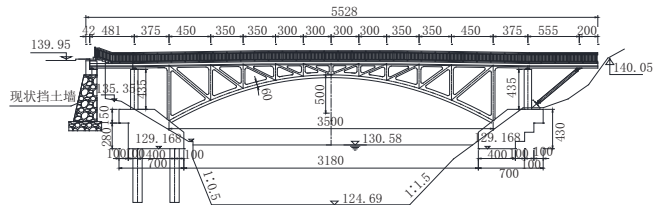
桥梁立面图(高程单位:m;尺寸单位:cm)
